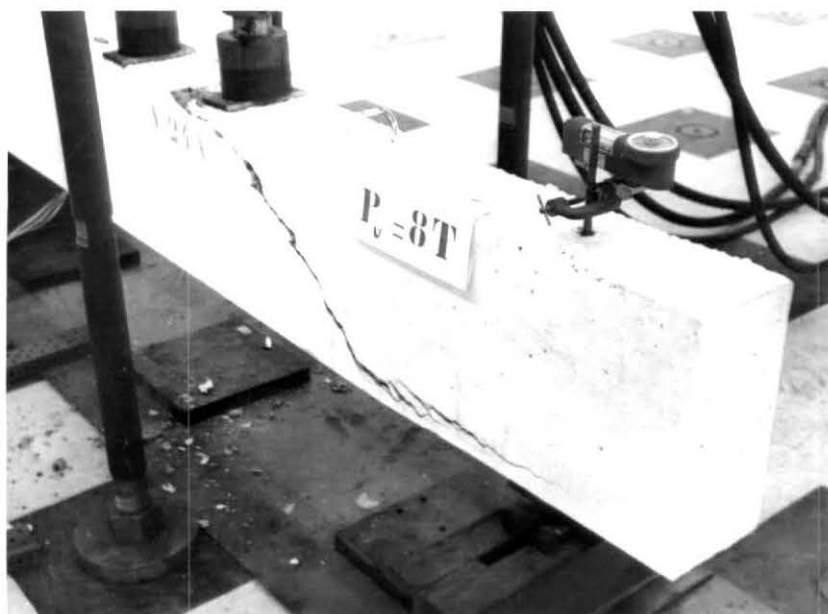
Detalhe da ruptura da viga 24A por esmagamento do concreto na zona comprimida.
